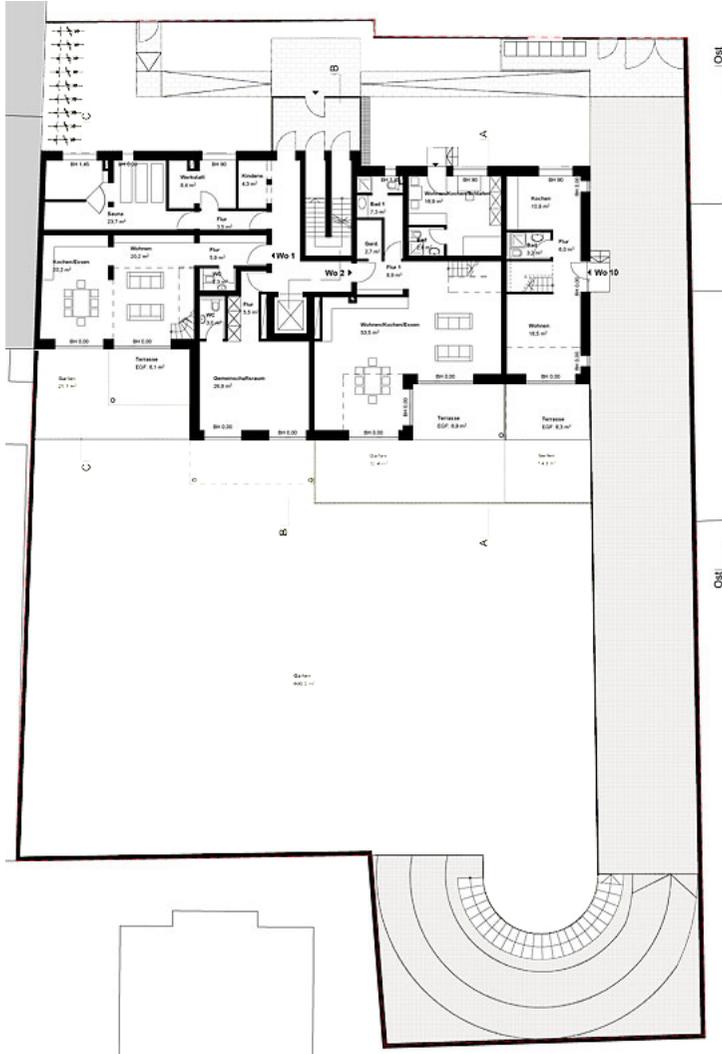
Wohngebäude Ostende, Grundriss Erdgeschoss mit Gemeinschaftsräumen: Gemeinschaftsraum (mit Küche), Werkstatt, Sauna, Gästewohnung
